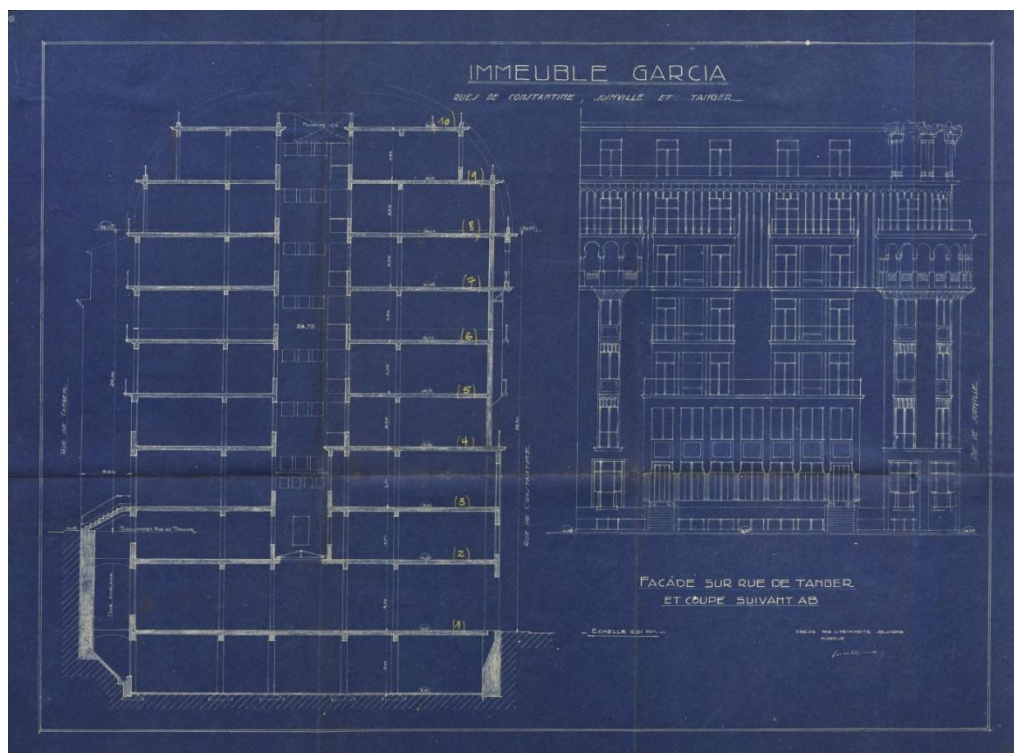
Façade sur rue de Tanger et coupe suivant AB
